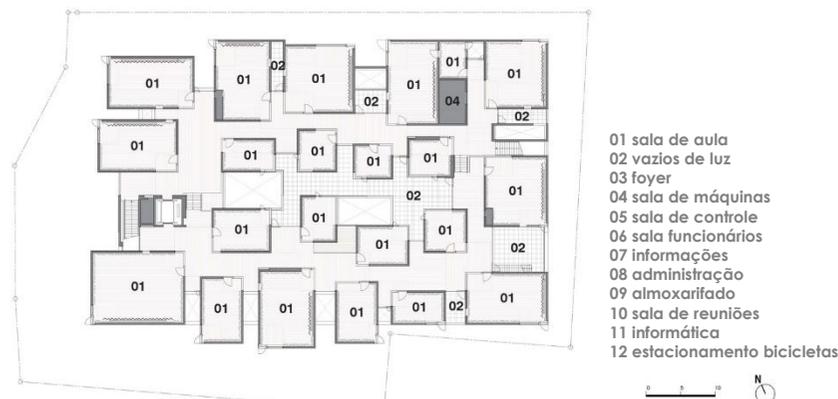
Planta Baixa 1º Pavimento_ Escola de Música Toho Gakuen, Tóquio. Fonte: Nikken Sekkei Architecture
